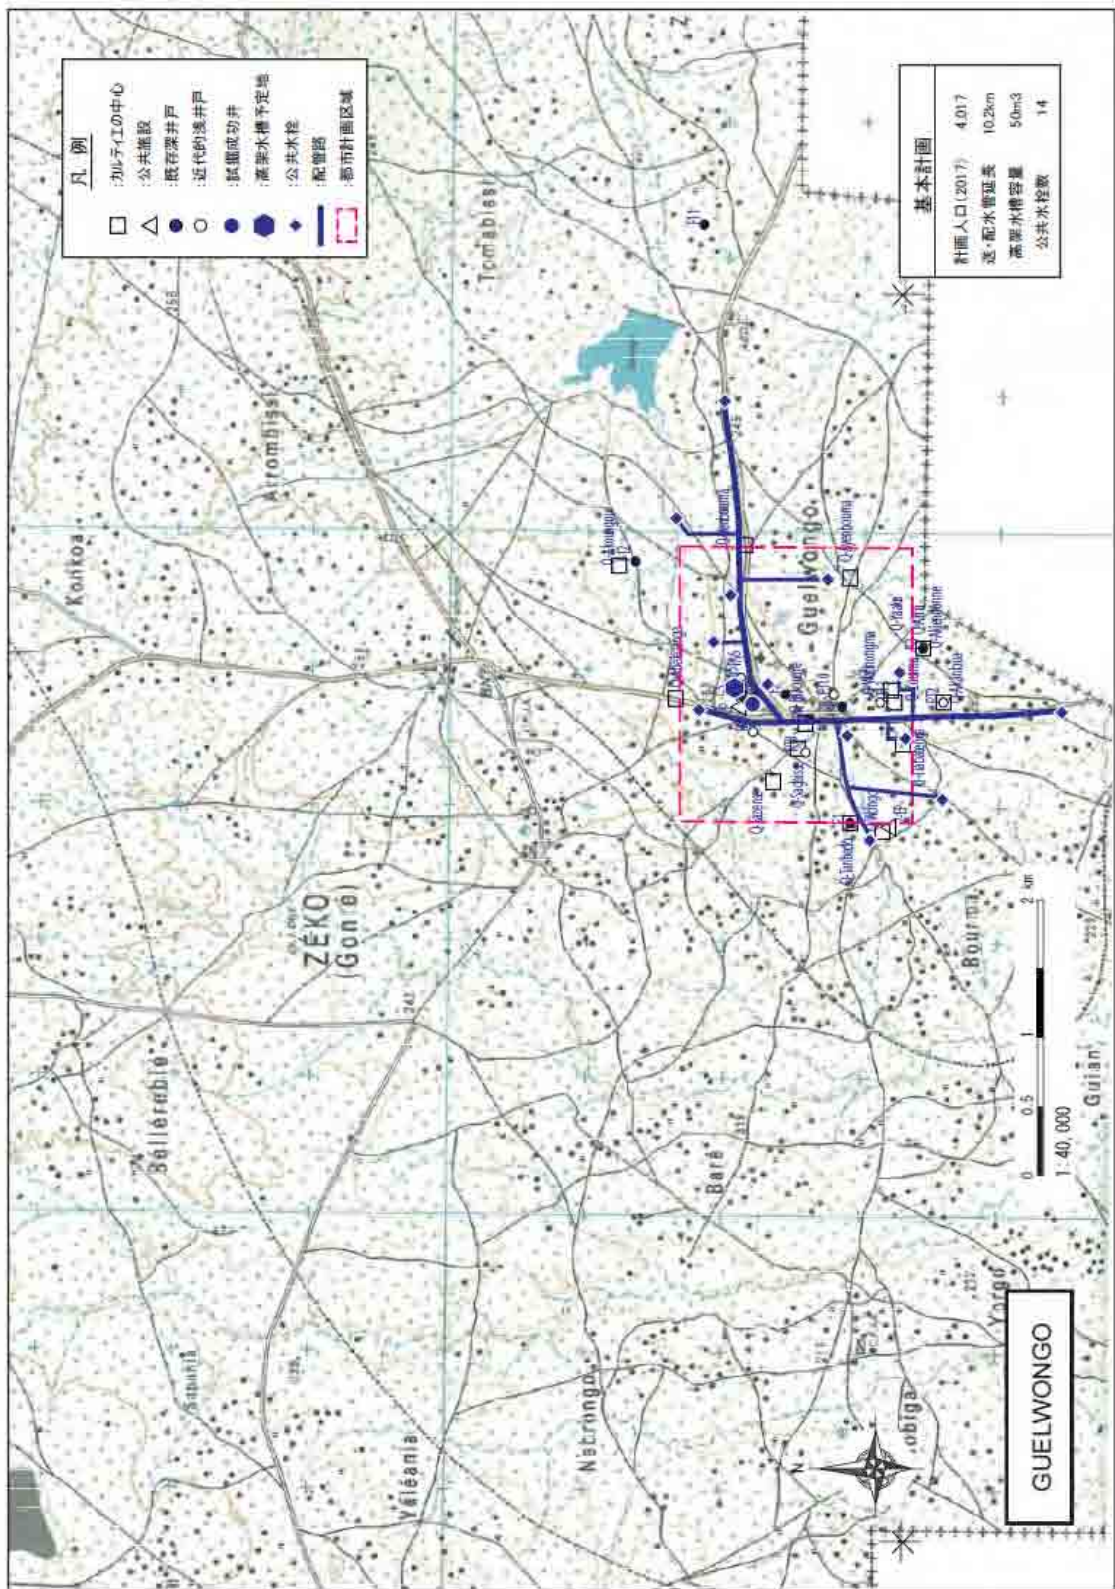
計画対象サイト(Guelwongo)の給水施設広域平面図
